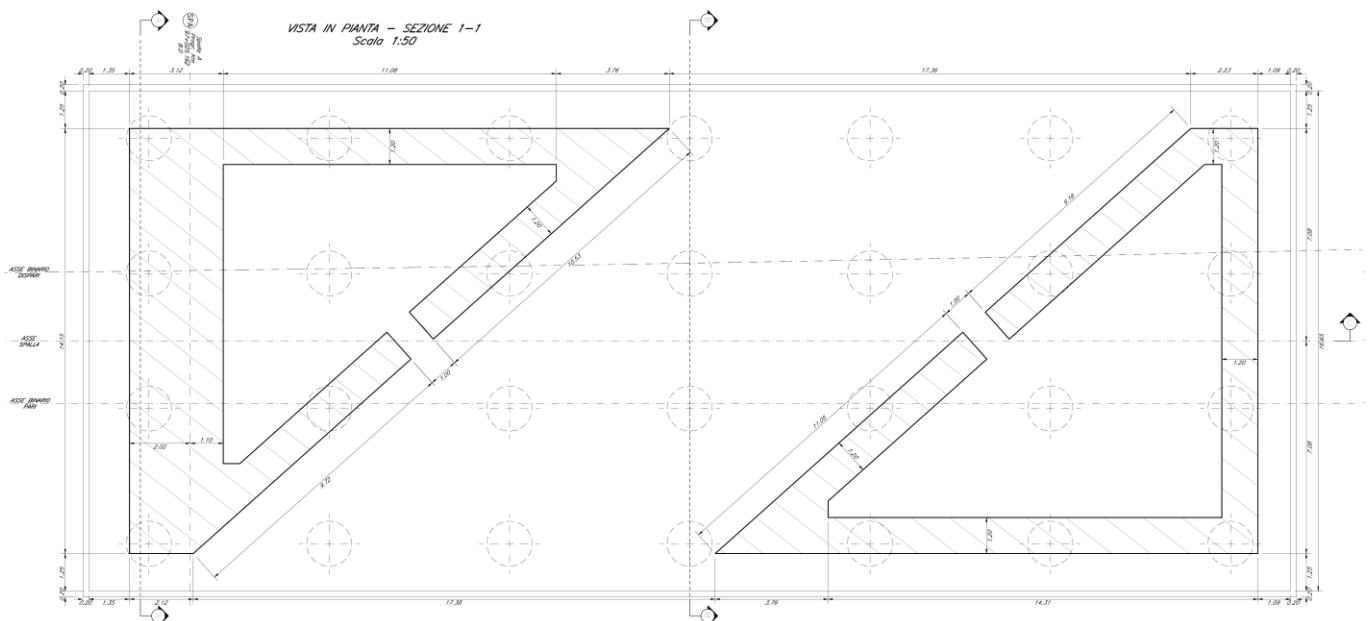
Vista in pianta della spalla A (manufatto scatolare) – Lato Genova.
